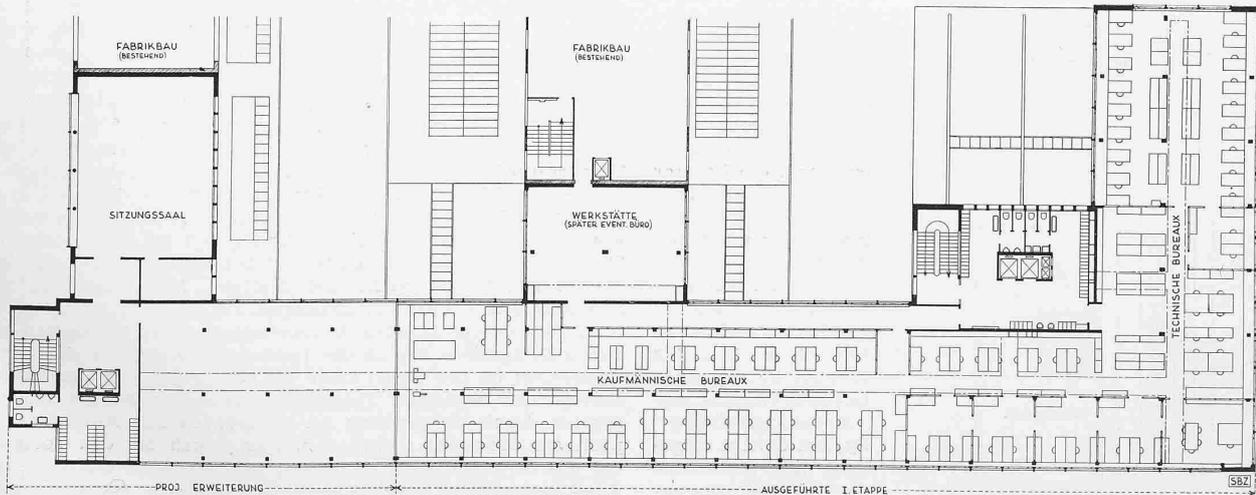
Grundriss vom 1. Obergeschoss. Darüber Abb. 8 bis 10, Schnitte
